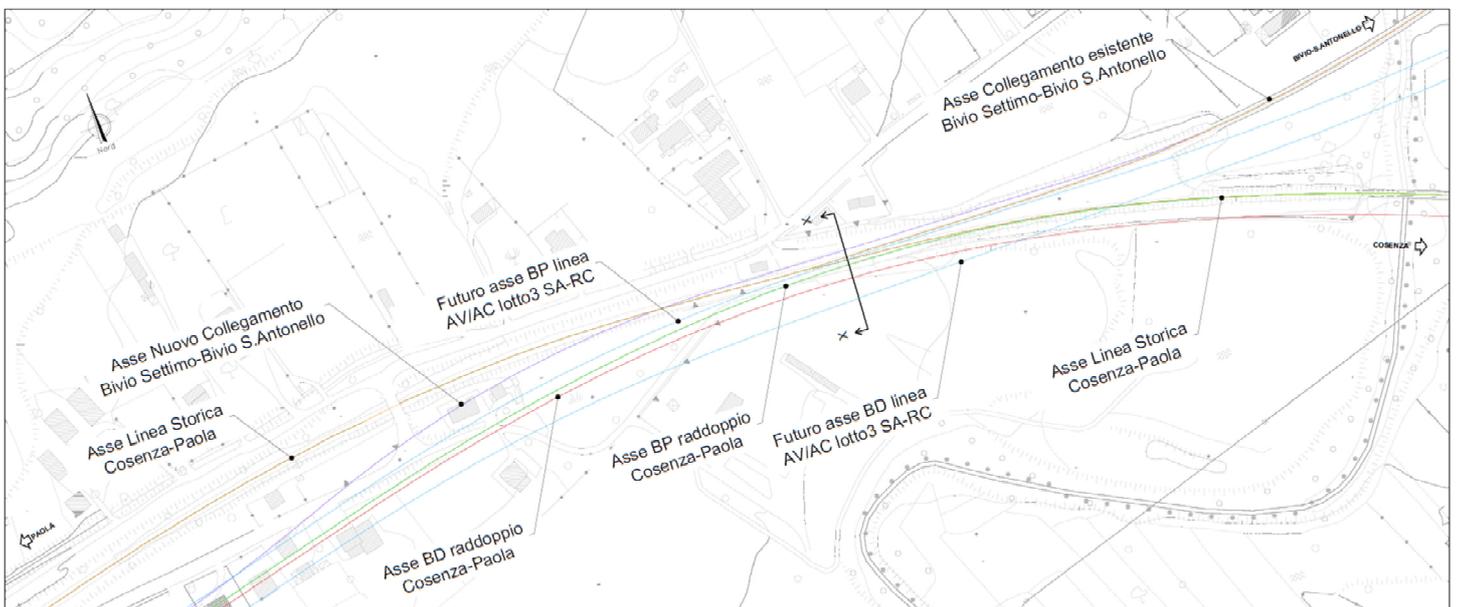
Stralcio planimetrico dell'innesto su C. Cosentino con individuazione della sezione trasversale studiata (X-X)
